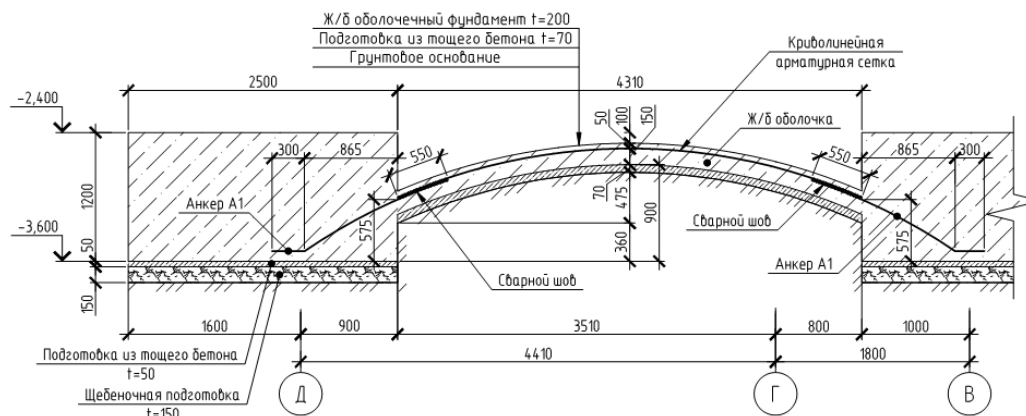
Схема армирования оболочки (для разреза 1-1)
